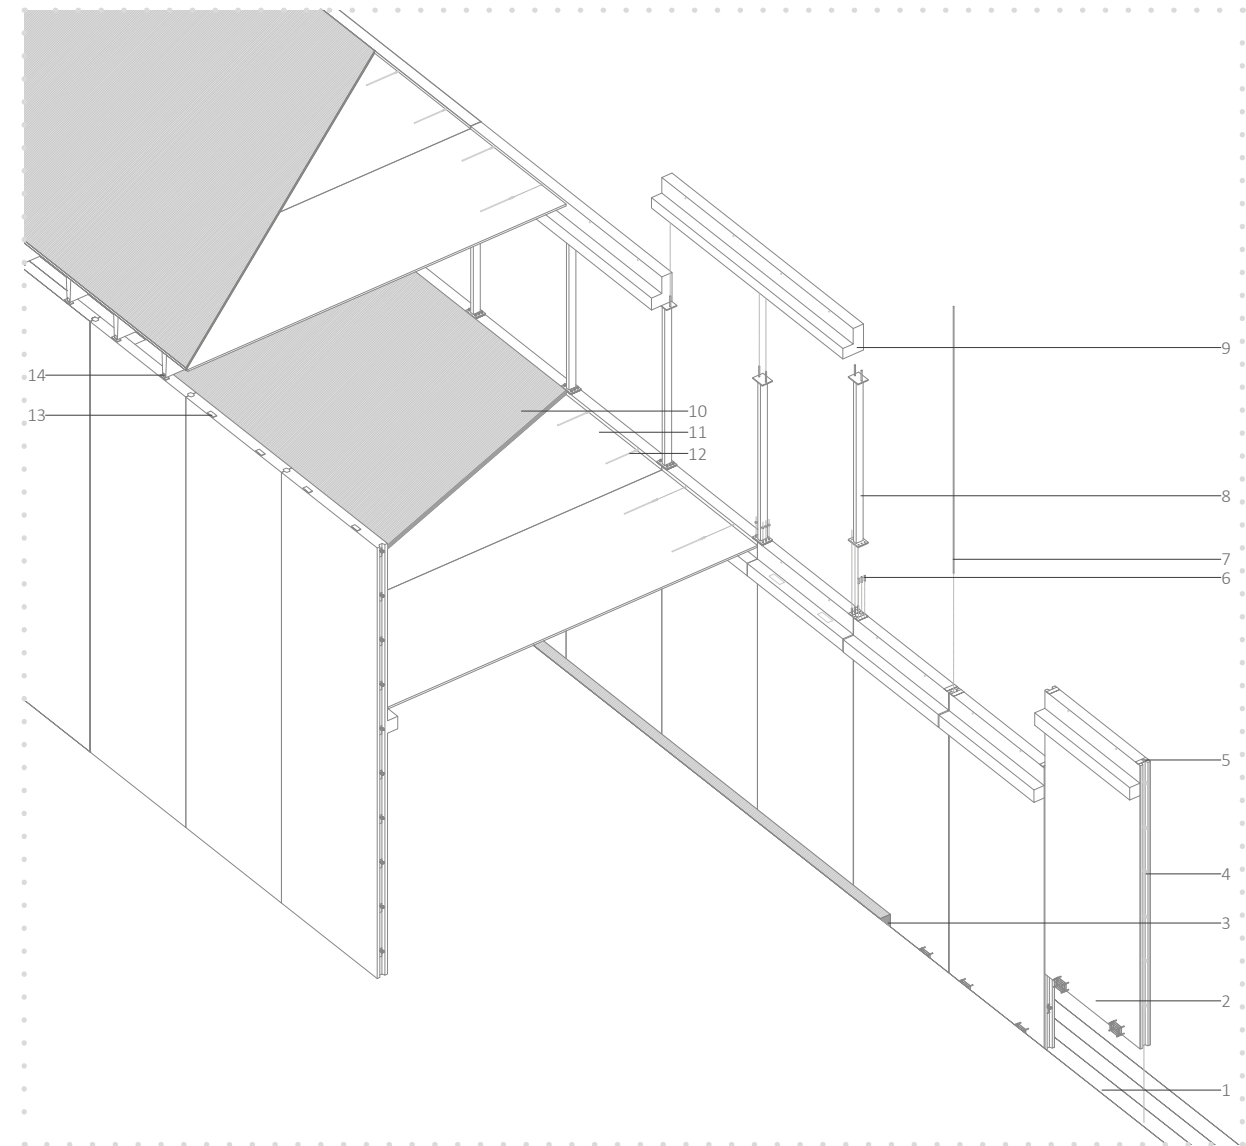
Vista general de la estructura y la obra gruesa de la casa Hormipresa.
